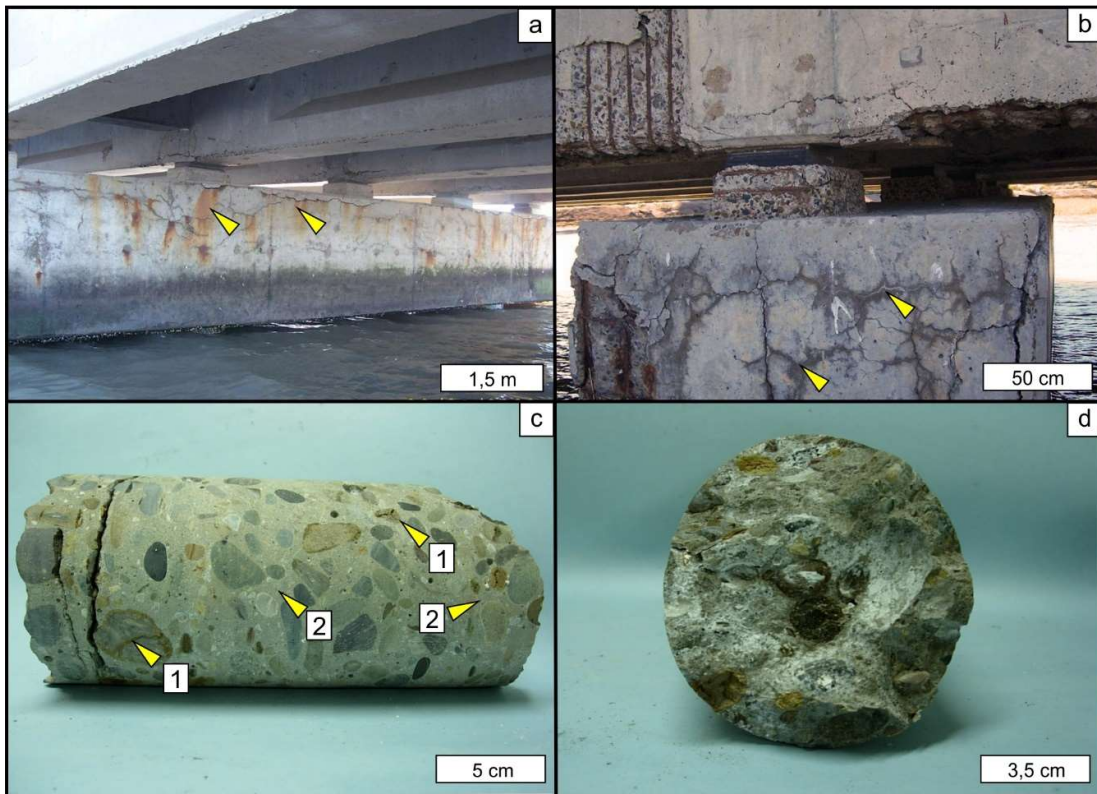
a) Cabezal de pilotes de un viaducto del puerto de Ing. White afectado por la RAS. Se observan fisuras horizontales en la parte superior del elemento estructural (flechas) asociadas a manchas rojizas producto de la corrosión de las armaduras. b) Vista de la sección transversal del cabezal donde se observan fisuras en forma de mapa asociadas a productos transparentes y blanquecinos debido a la RAS (flechas) y pérdida del hormigón de recubrimiento con exposición de las armaduras (izquierda). c) Testigo de hormigón extraído de la estructura. Se reconocen fisuras que afectan el interior de los agregados (1) así como la pasta de cemento (2). d) Detalle de la sección transversal interna del testigo con marcado desarrollo de productos de neoformación blanquecinos.
